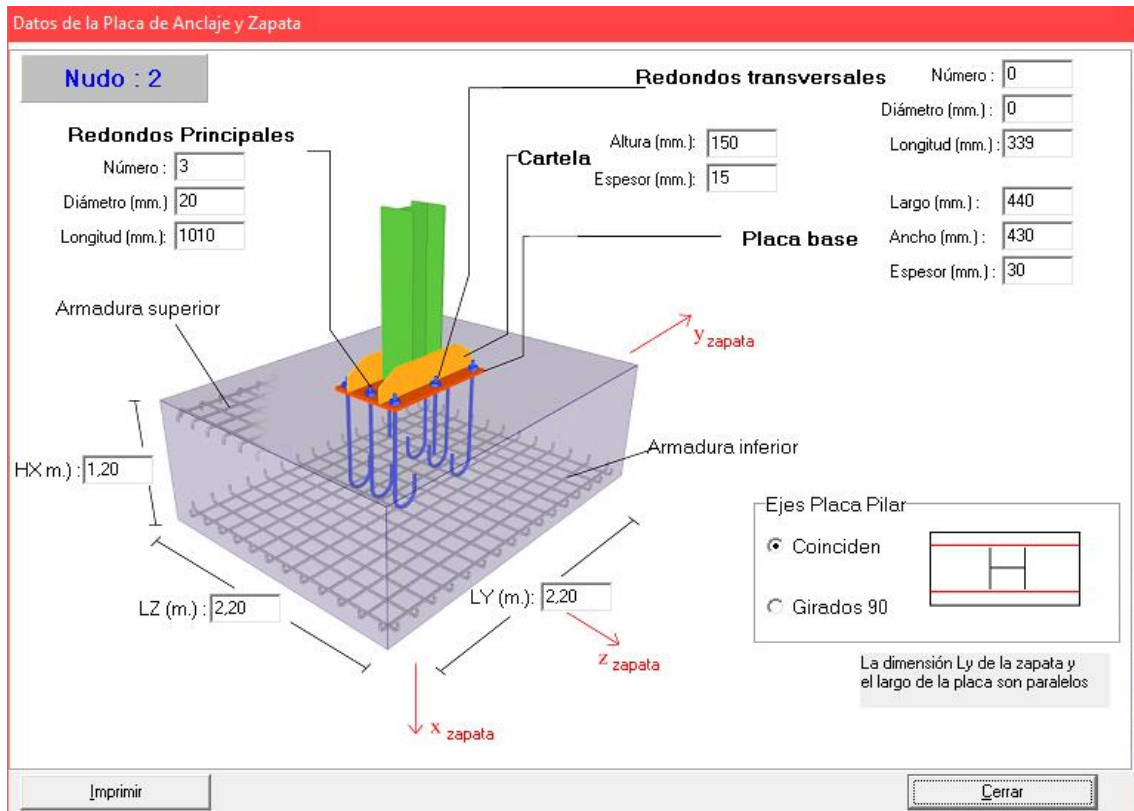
Detalle zapata tipo 2 (Nudo 2). Fuente: Metalpla XE 64
